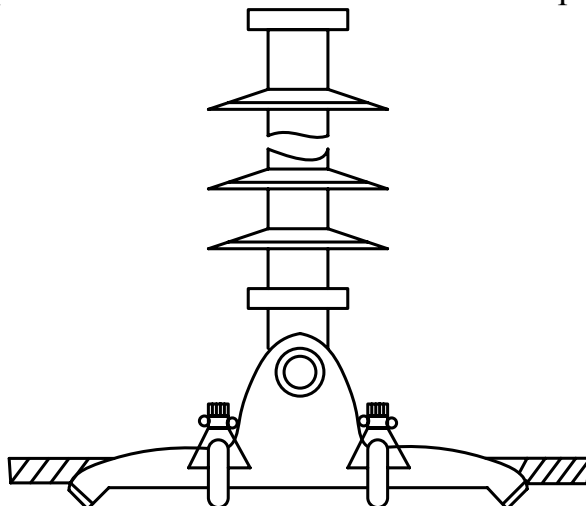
Крепление проводов на промежуточных опорах с подвесными изоляторами
